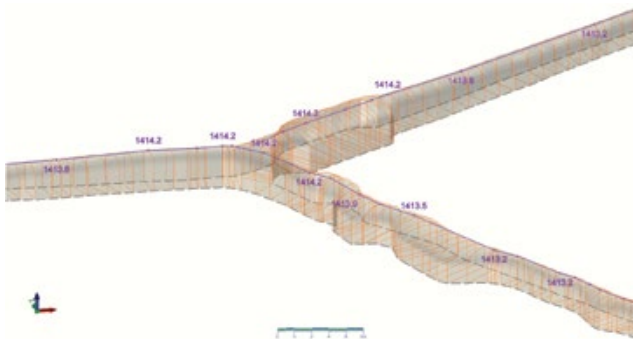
Построение каркаса по боковым стенкам с учетом точек кровли и подошвы
